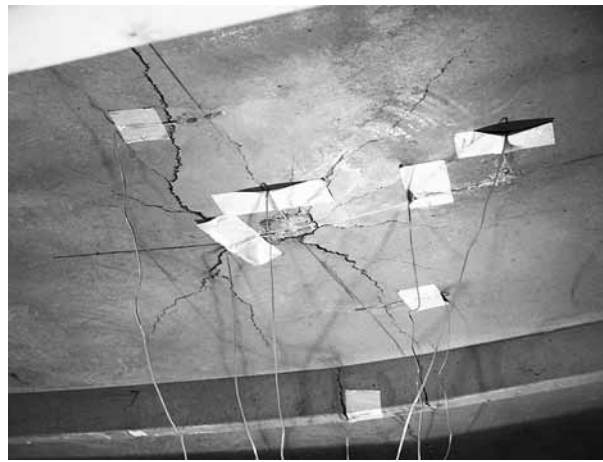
Rissbild an der Plattenunterseite für die Plattenkonfiguration mit bewehrten Trapezrippen, kurz vor dem Versagen
